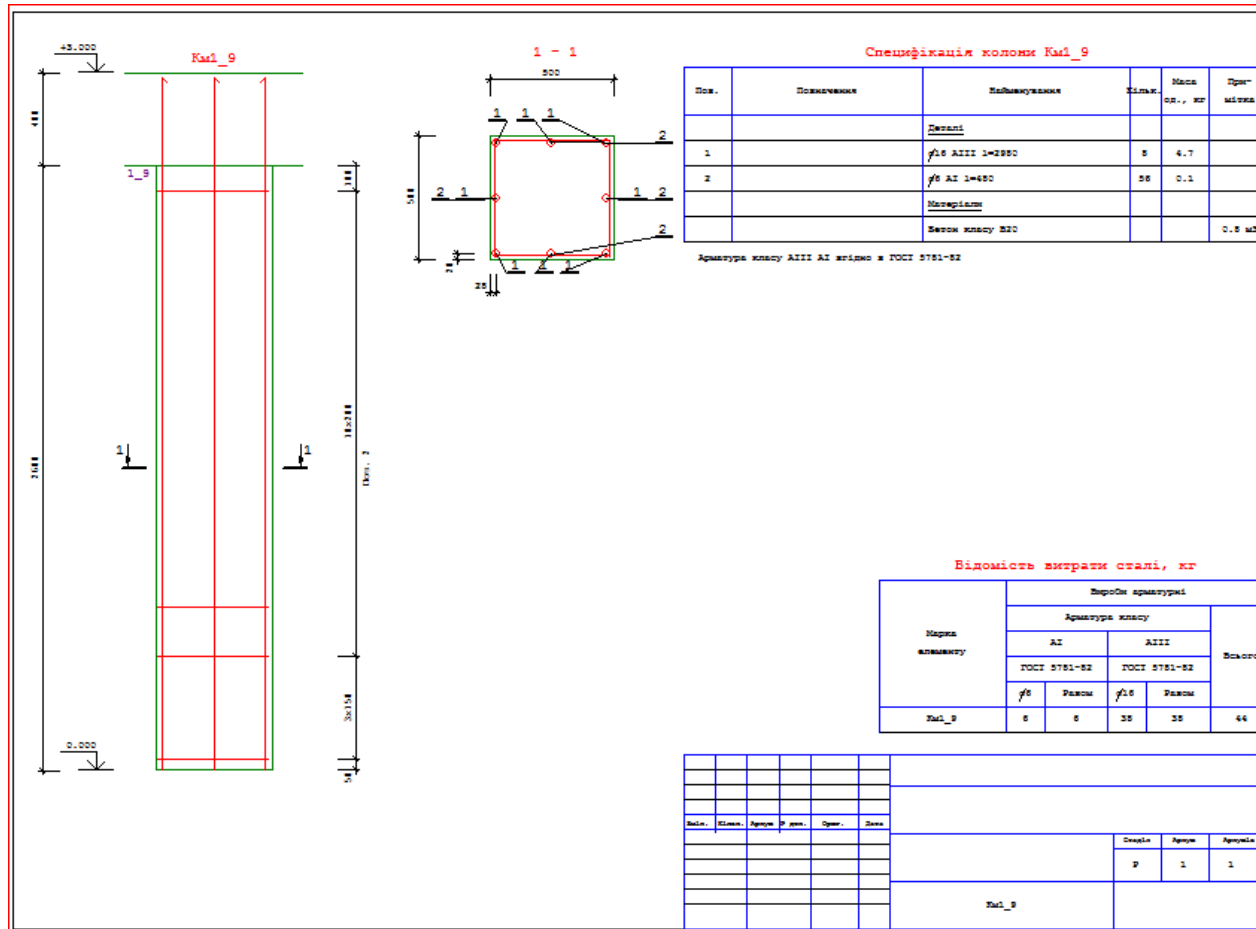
Варіант балково-плитного перекриття. Колонна 1-9. Креслення робочого проекту
